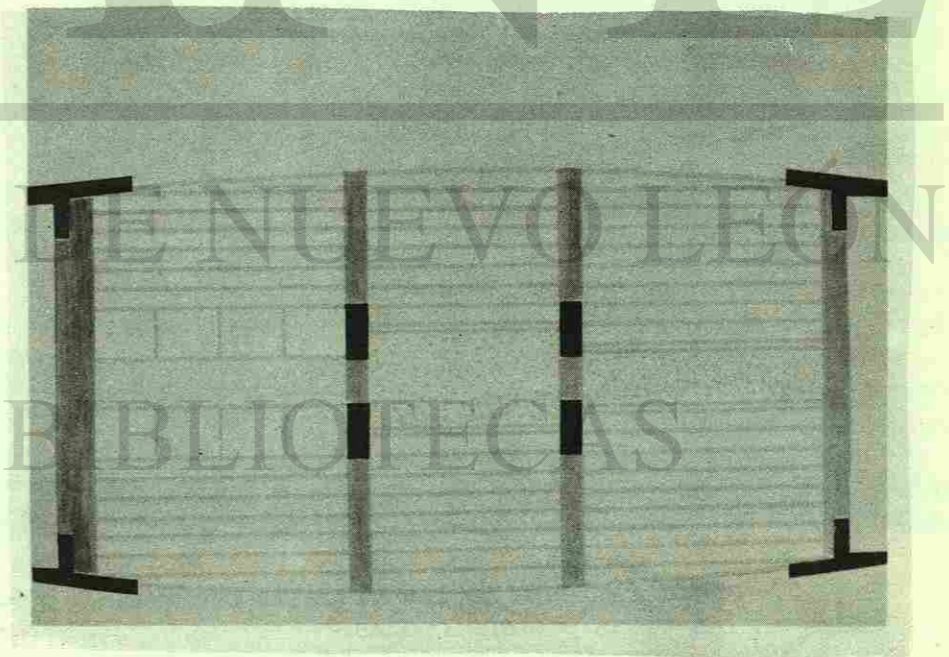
Sistema B. Pisos típicos que muestran 4 vigas postensadas soportando viguetas prefabricadas y pretensadas.
